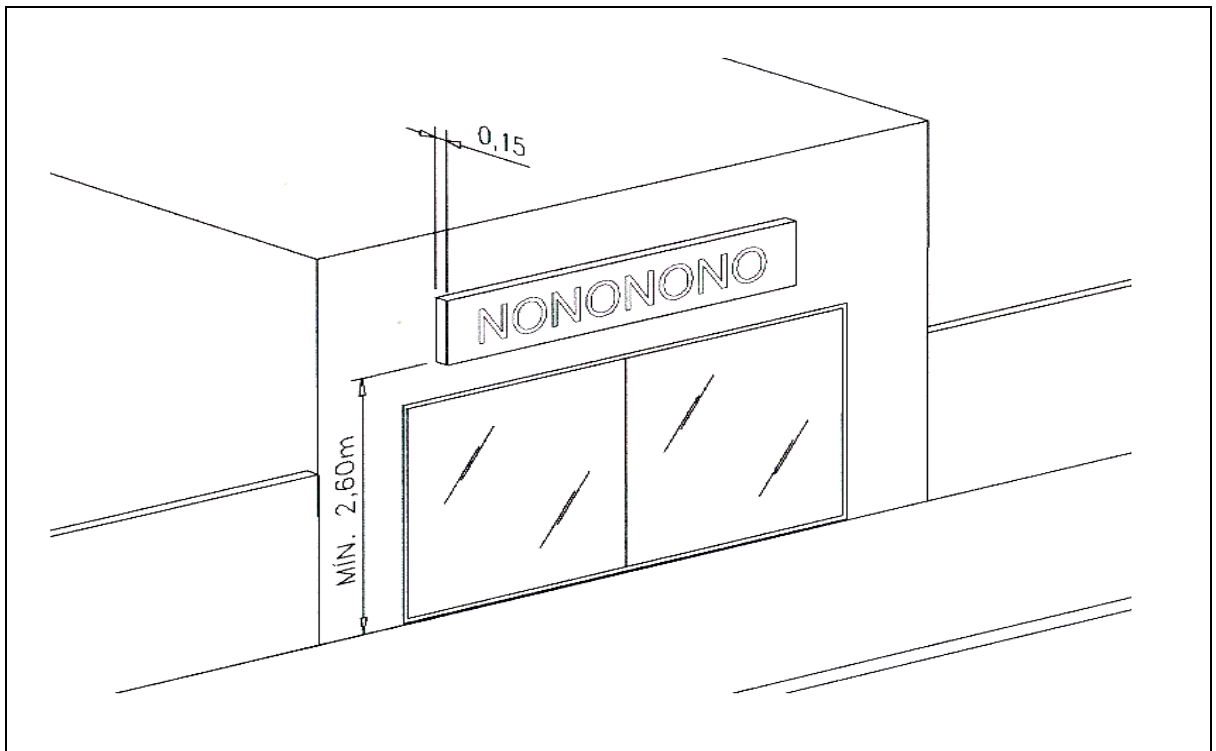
Anúncio Indicativo em estabelecimentos edificadas no alinhamento frontal do lote. – Paralelo à fachada.
